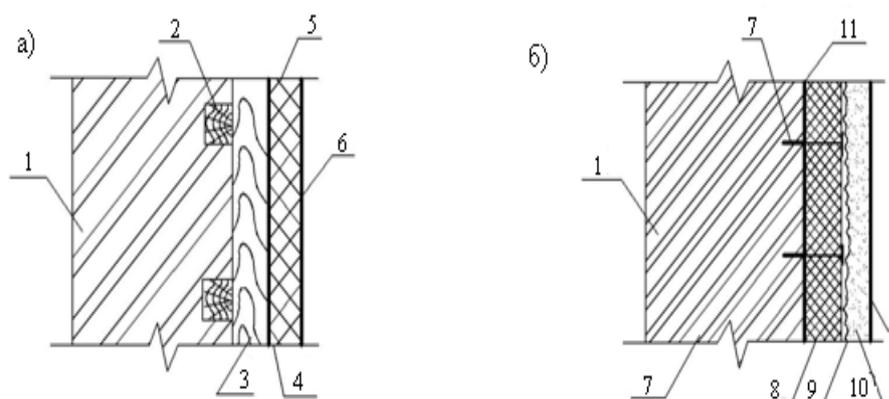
Схема утепления стен теплоизоляционной штукатуркой:
